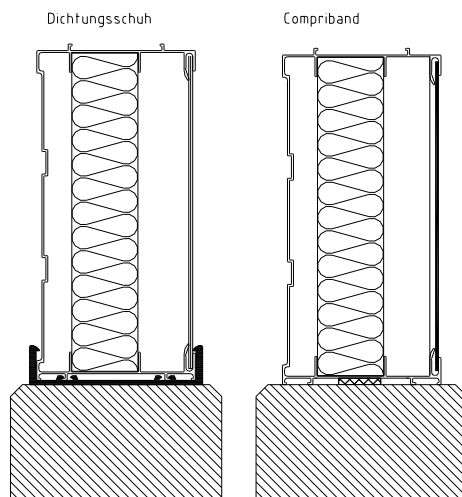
Auflagerung auf Sockelelementen aus Stahlbeton
